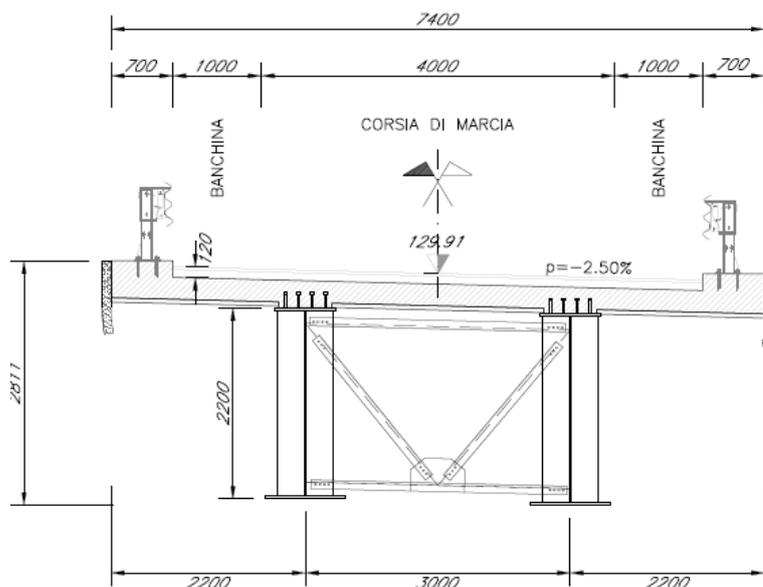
Sezione trasversale dell'impalcato in corrispondenza del traverso di campata
